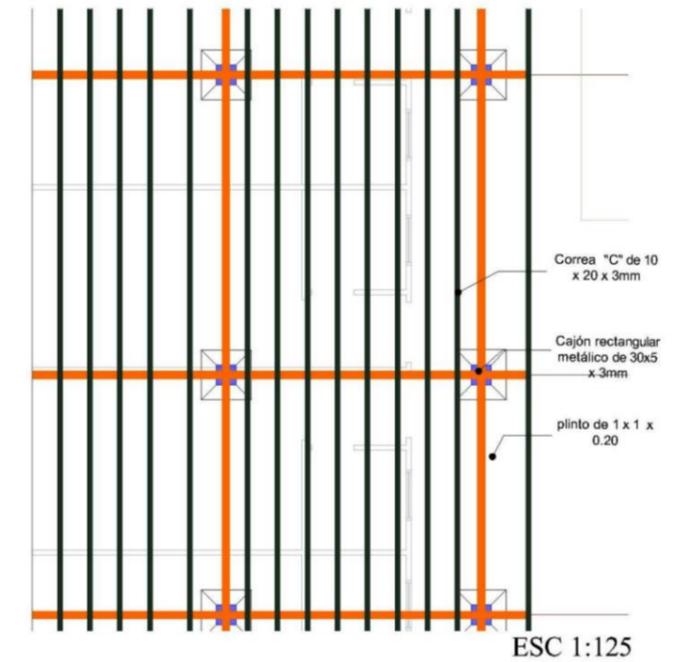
Planta Detalle de estructura de cimentación y de Piso
